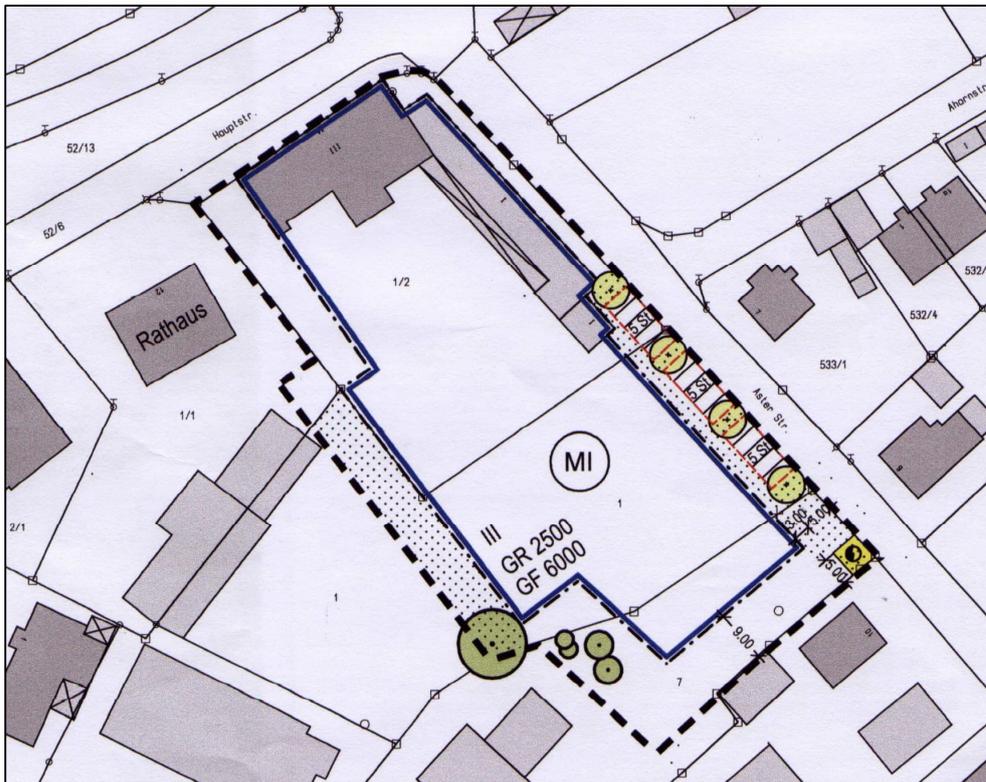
Planzeichnung zum Bebauungsplan "Mischgebiet – Hauptstraße" der Gemeinde Echting /15/
